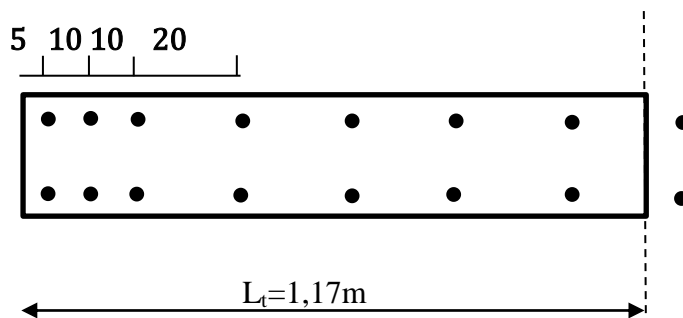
Disposition des armatures verticales sur la longueur tendue du voile
